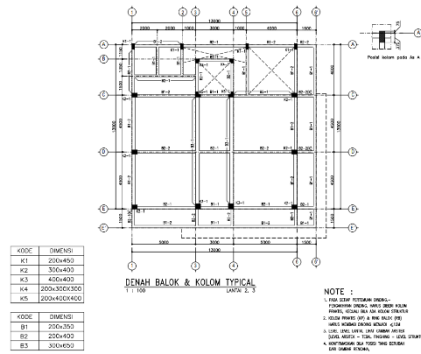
Denah Lantai Mezzanin Struktur Gedung di Surabaya
